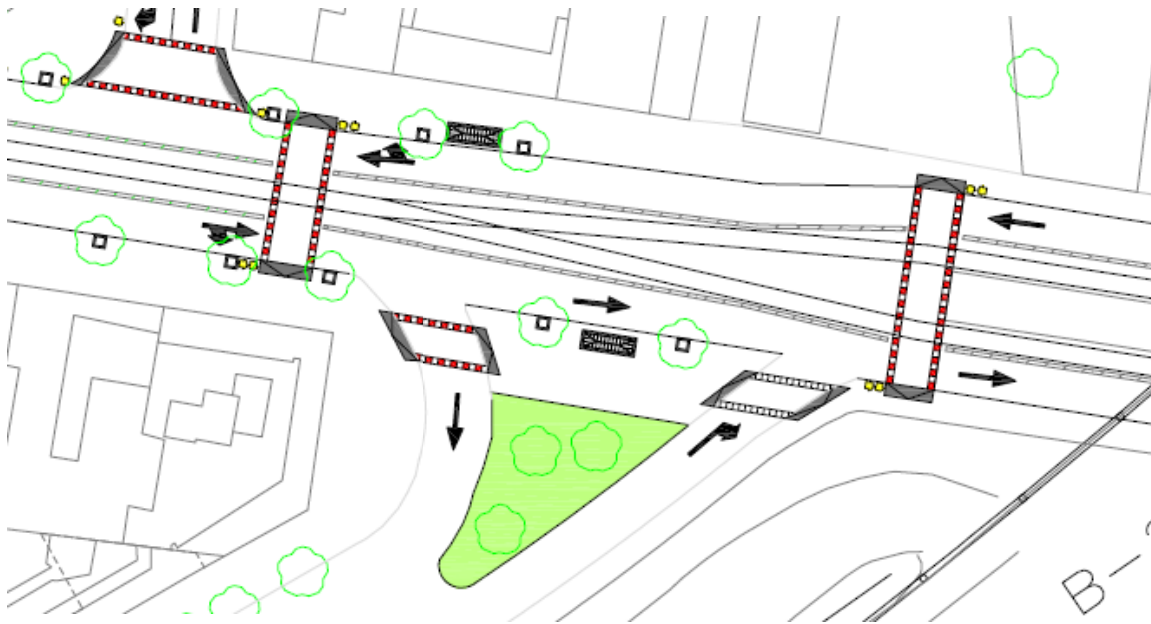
Vista en planta de Laureà Miró con puente B-23. Paso de vía doble a vía única.
